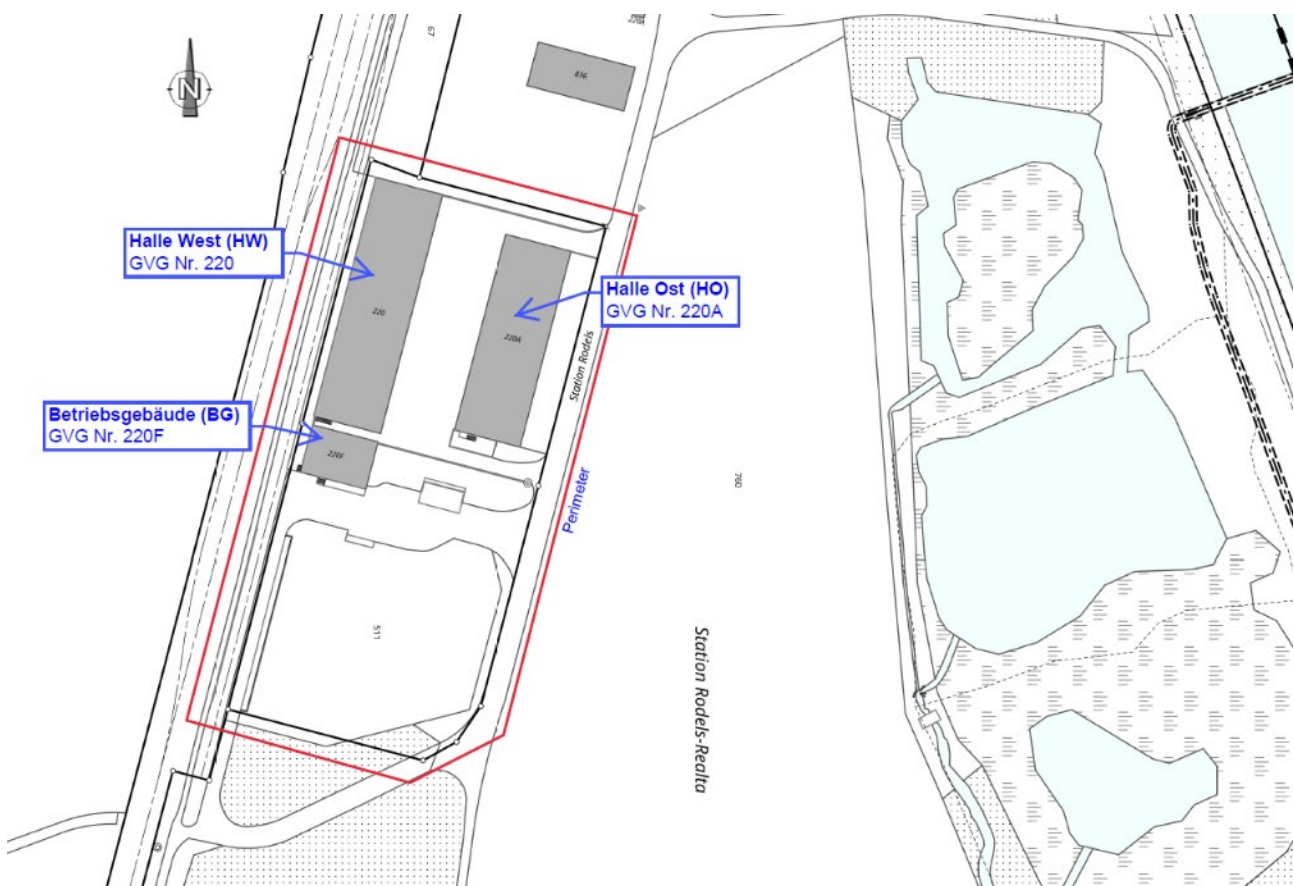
Situationsplan mit Gebäudebezeichnungen
